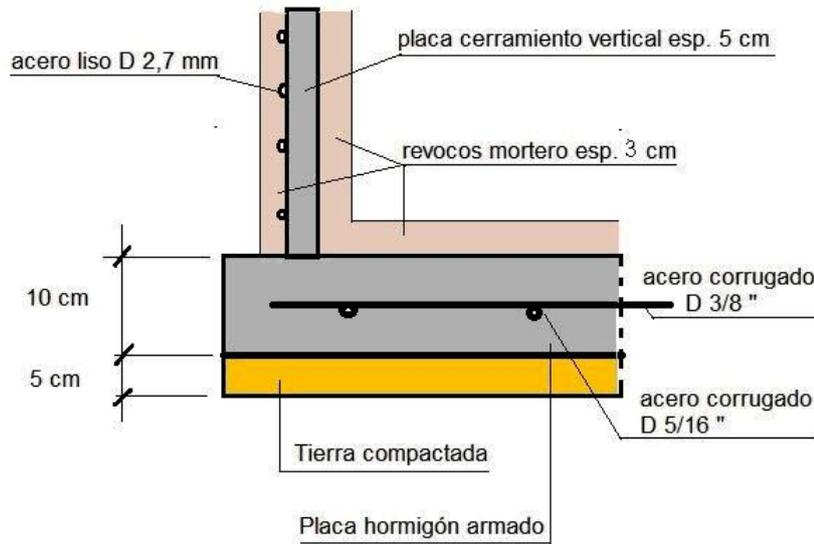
Detalle de la losa y arranque del muro de cerramiento lateral
